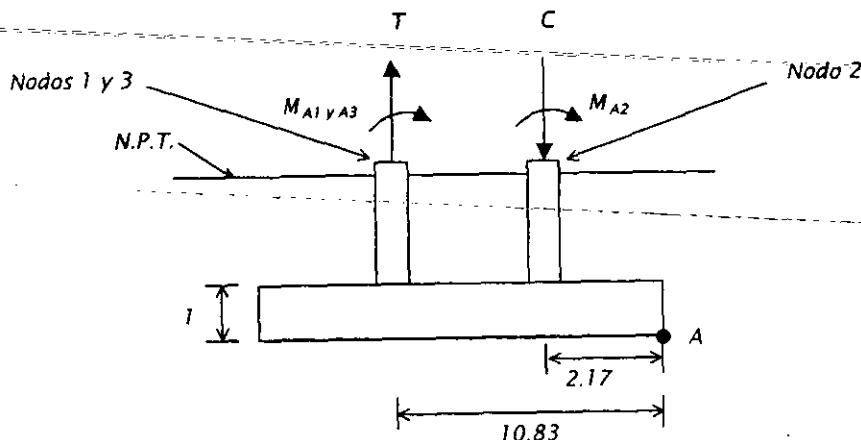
Esquema de Losa-en-Planta y Elevación (Unidades en metros).
